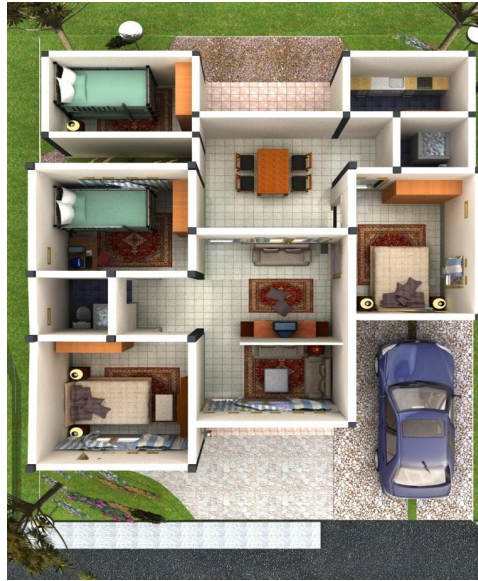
Denah Desain Baru Konsep Desain *Renovable
